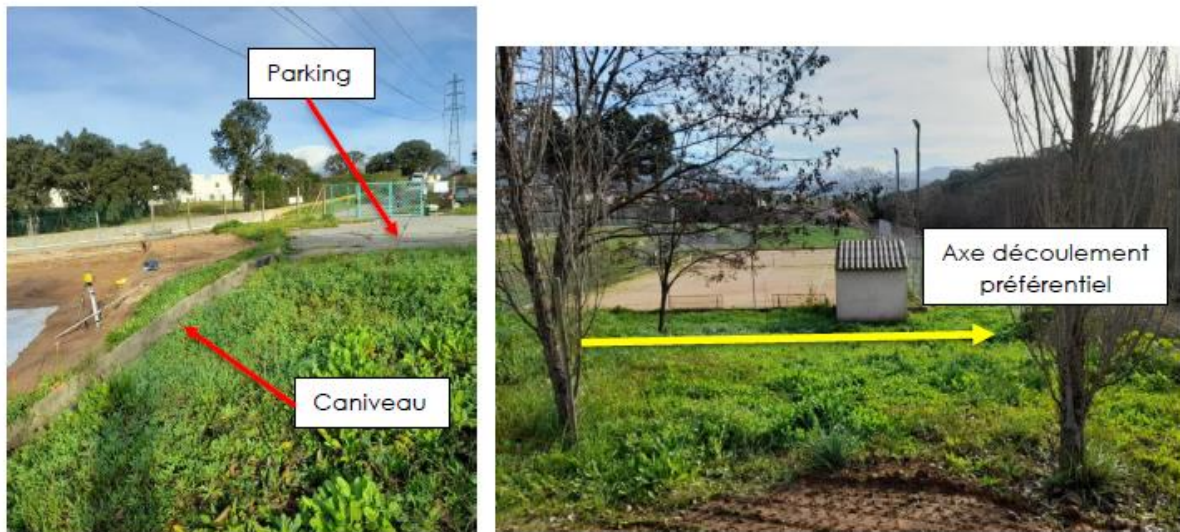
Photographies du site d'étude. Source : GEOTEC -12/01/2023
